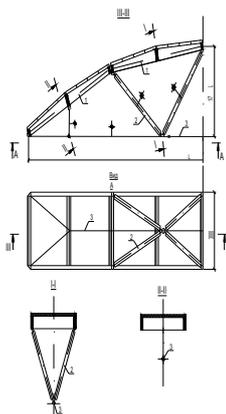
Полигональная четырехпанельная ферма: 1 - сталь верхнего пояса; 2 - раскосы из круглой квадратной стали; 3 - нижний пояс из круглой стали.
